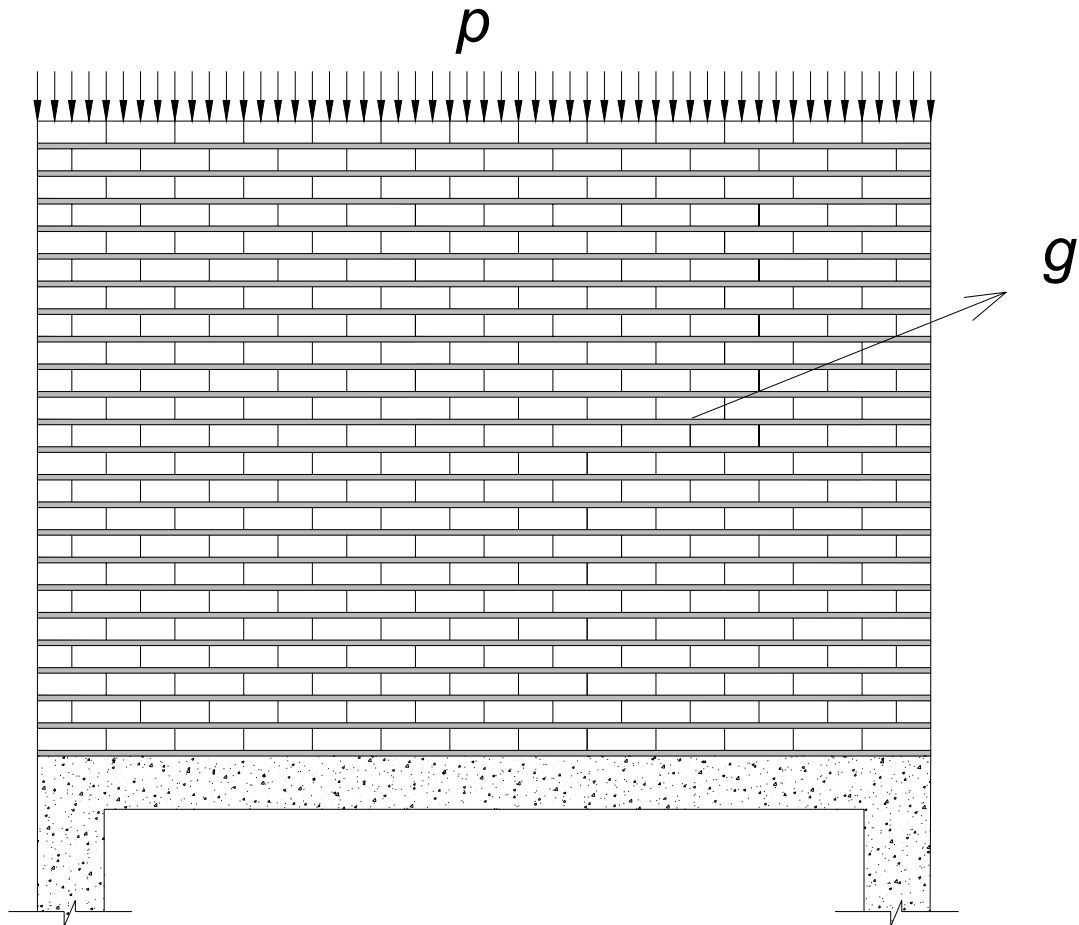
Muro de mampostería sobre pórtico de hormigón.
